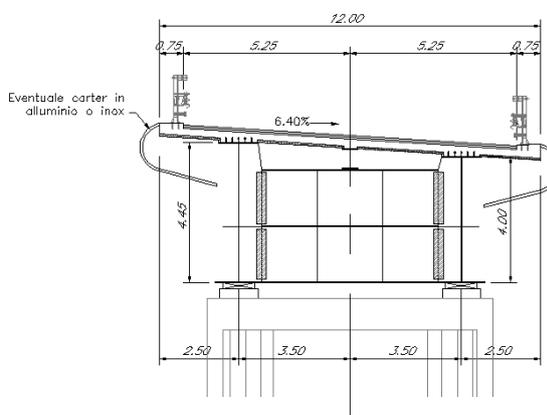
Sezioni trasversali tipo in asse alle pile e corrente
